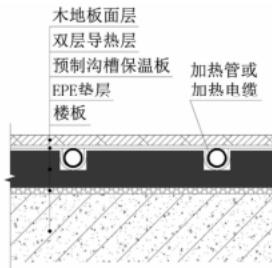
预制沟槽保温板供暖地面构造(一)
